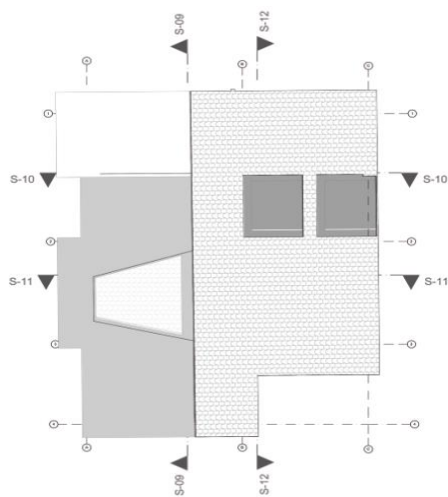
Planta de Cubiertas Nivel 2 Vivienda 3. Autoría propia.
